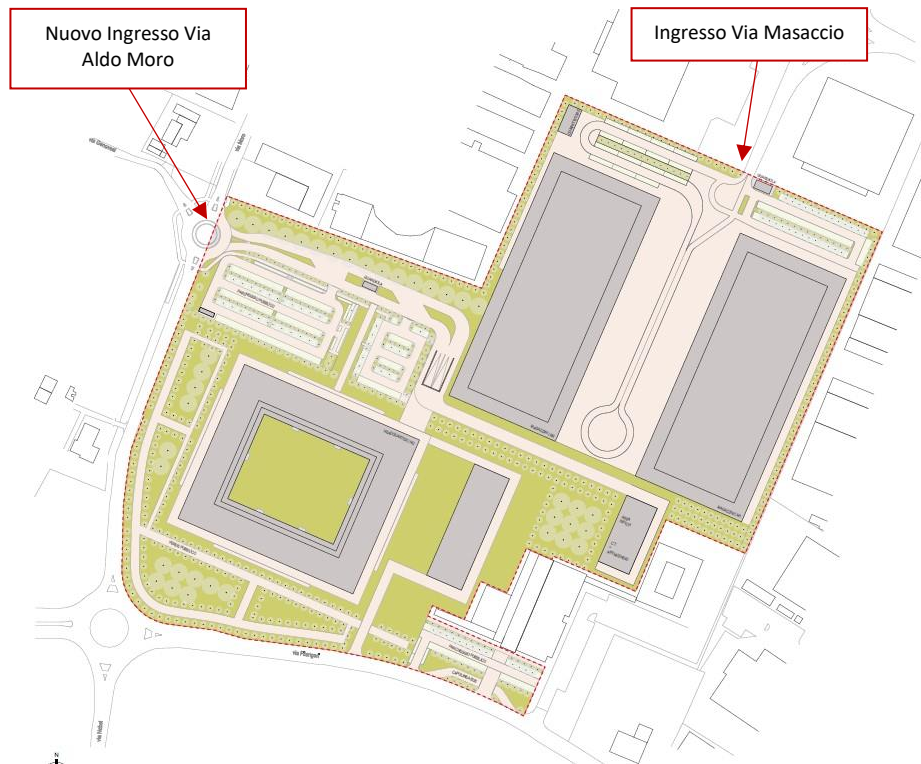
Stralcio elaborato 20 del PAIP “Planimetria esemplificativa di progetto” con indicati i due accessi all’area
